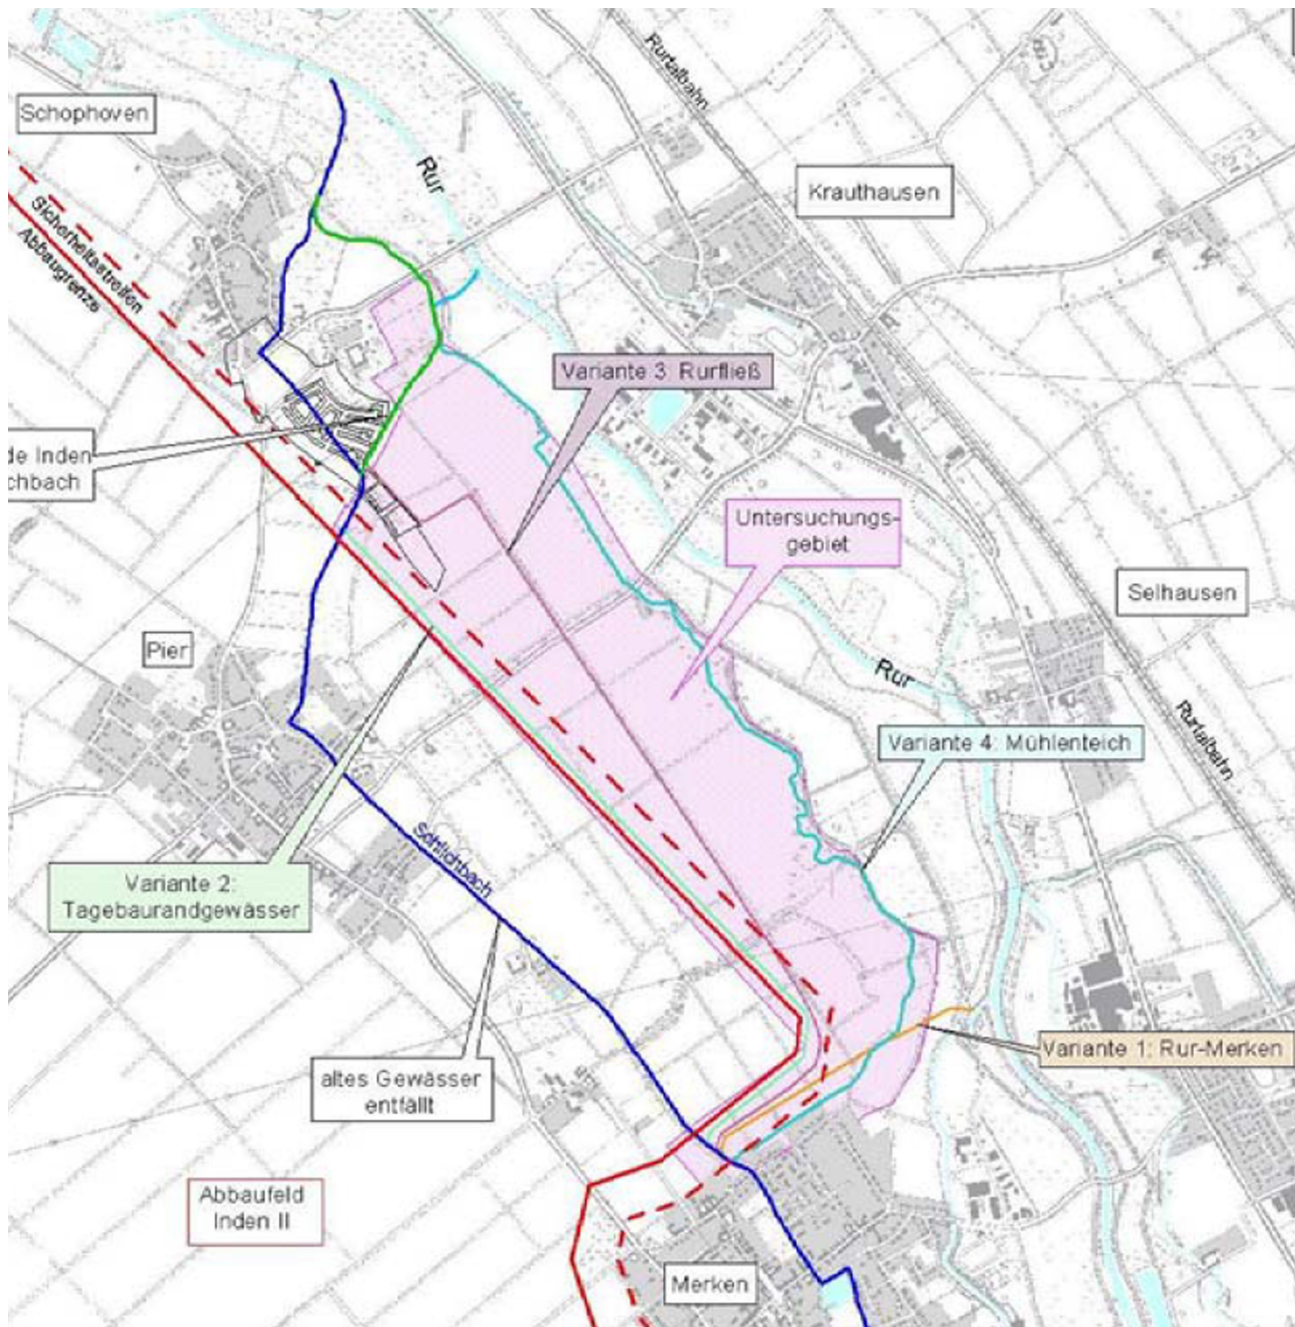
Lageplan mit der „Mühlenteich-Variante“ (Variante 4) als bevorzugte Planungsvariante.
